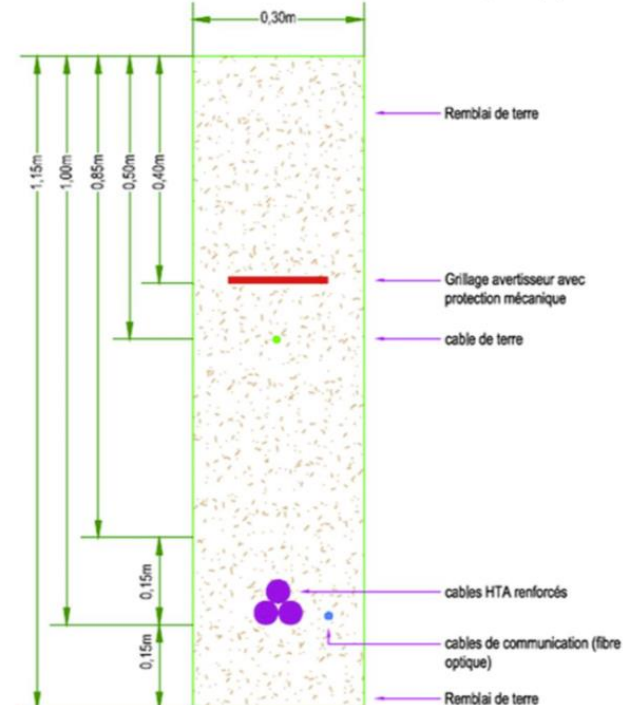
Coupe d'une tranchée pour implantation des câbles au sein des zones humides du projet
